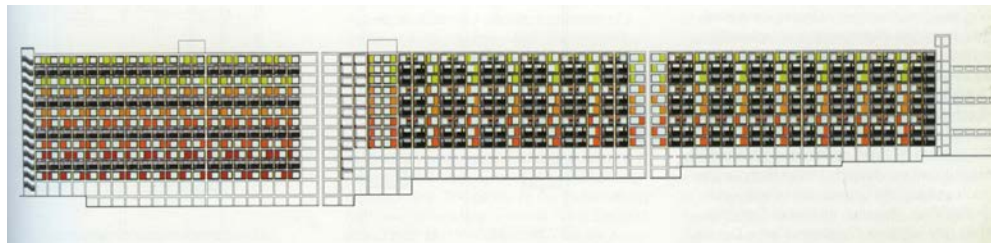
Alzado de la nueva propuesta. En Detail en 2013.
